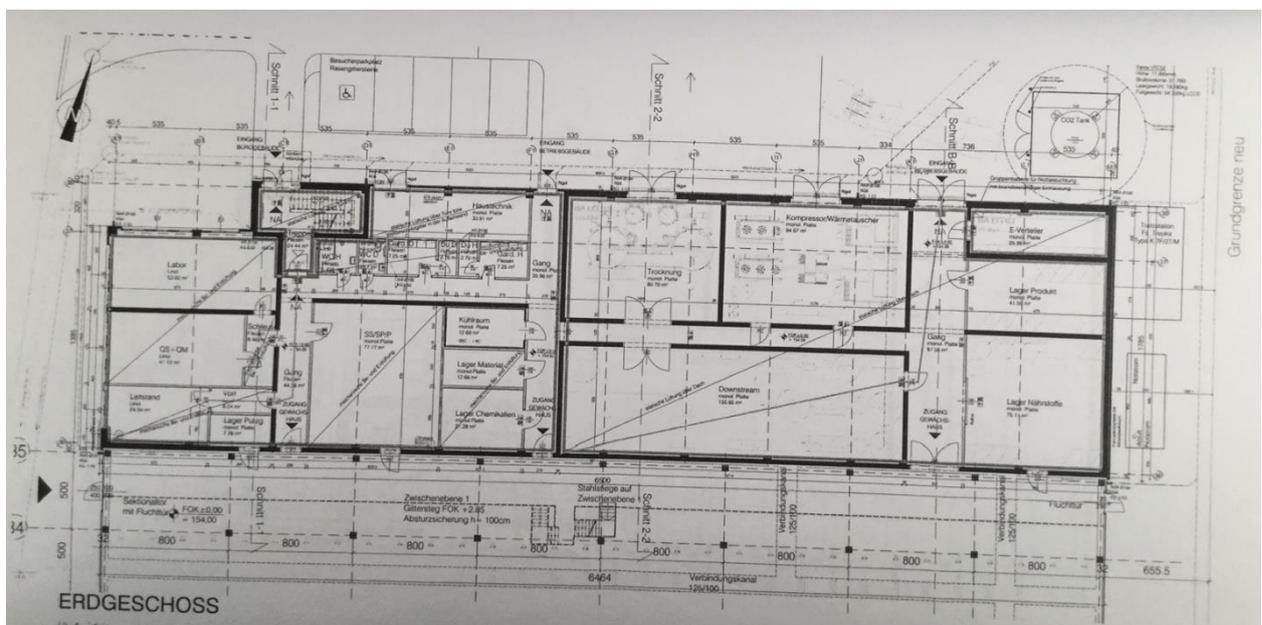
; Gebäudekomplex Büro u Betriebsgebäude Grundriss EG, o.M.
